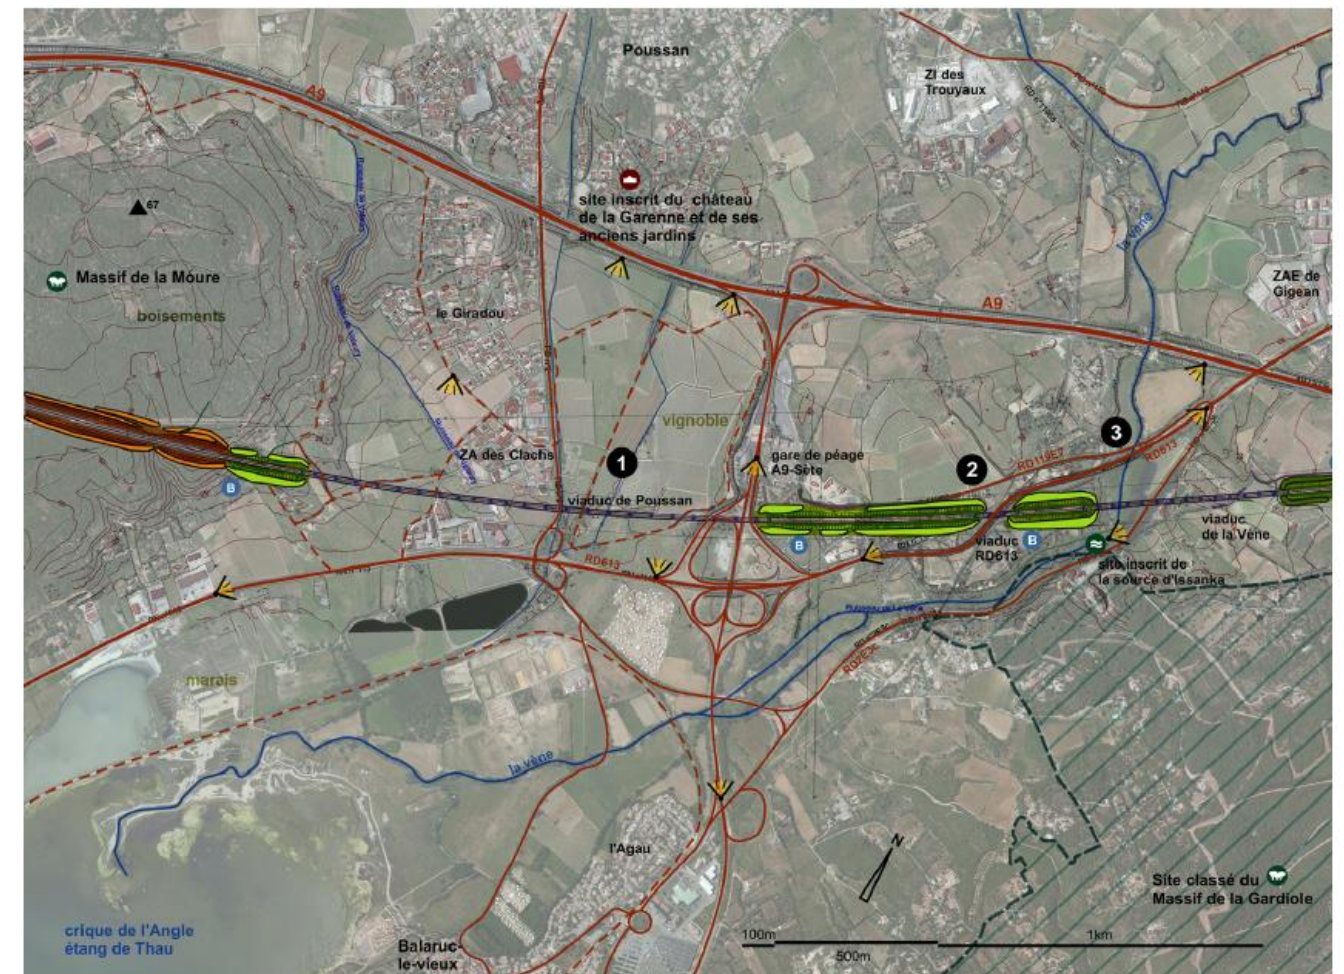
plan des mesures paysagères dans la traversée de la plaine de Poussan (source : Traverses)
